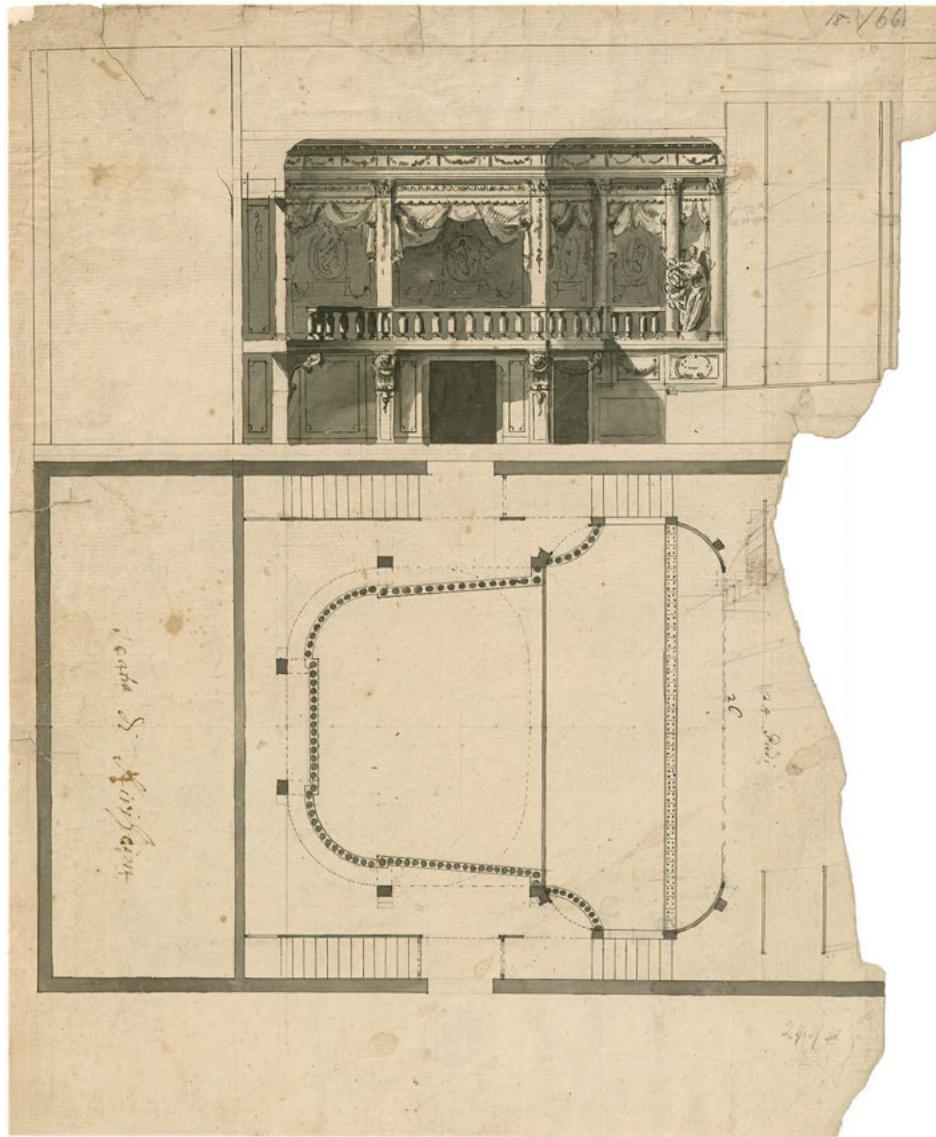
Giosu  Scotti: *Teatro di Kirchheim*, Grundriss und L ngsschnitt, Feder, laviert. Ludwigsburg, Ludwigsburg Museum, 515.
